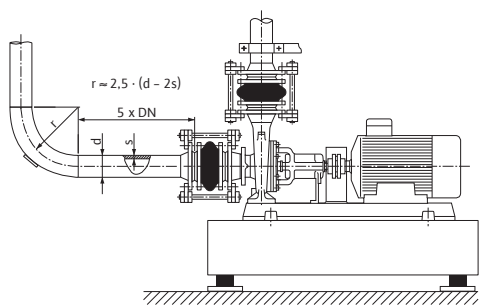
Подсоединение насоса без создания механических напряжений, участок выравнивания потока перед и за насосом
